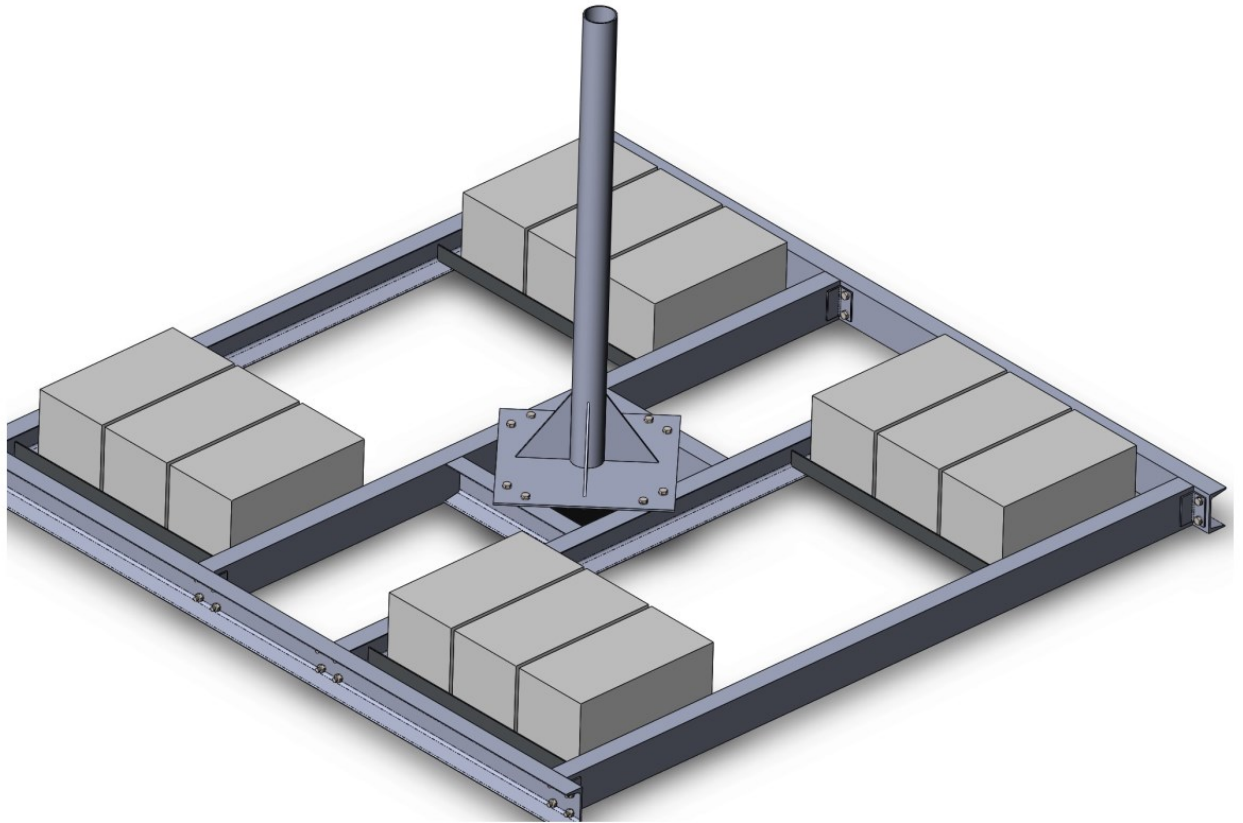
Размещение бетонных блоков на опорной площадке (типовое)
